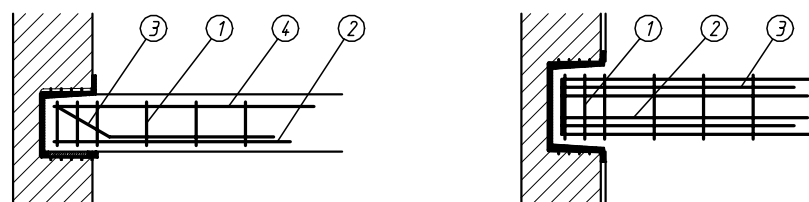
Bewehrungsführung für Treppenlaufanschlüsse mit Steckbügeln
